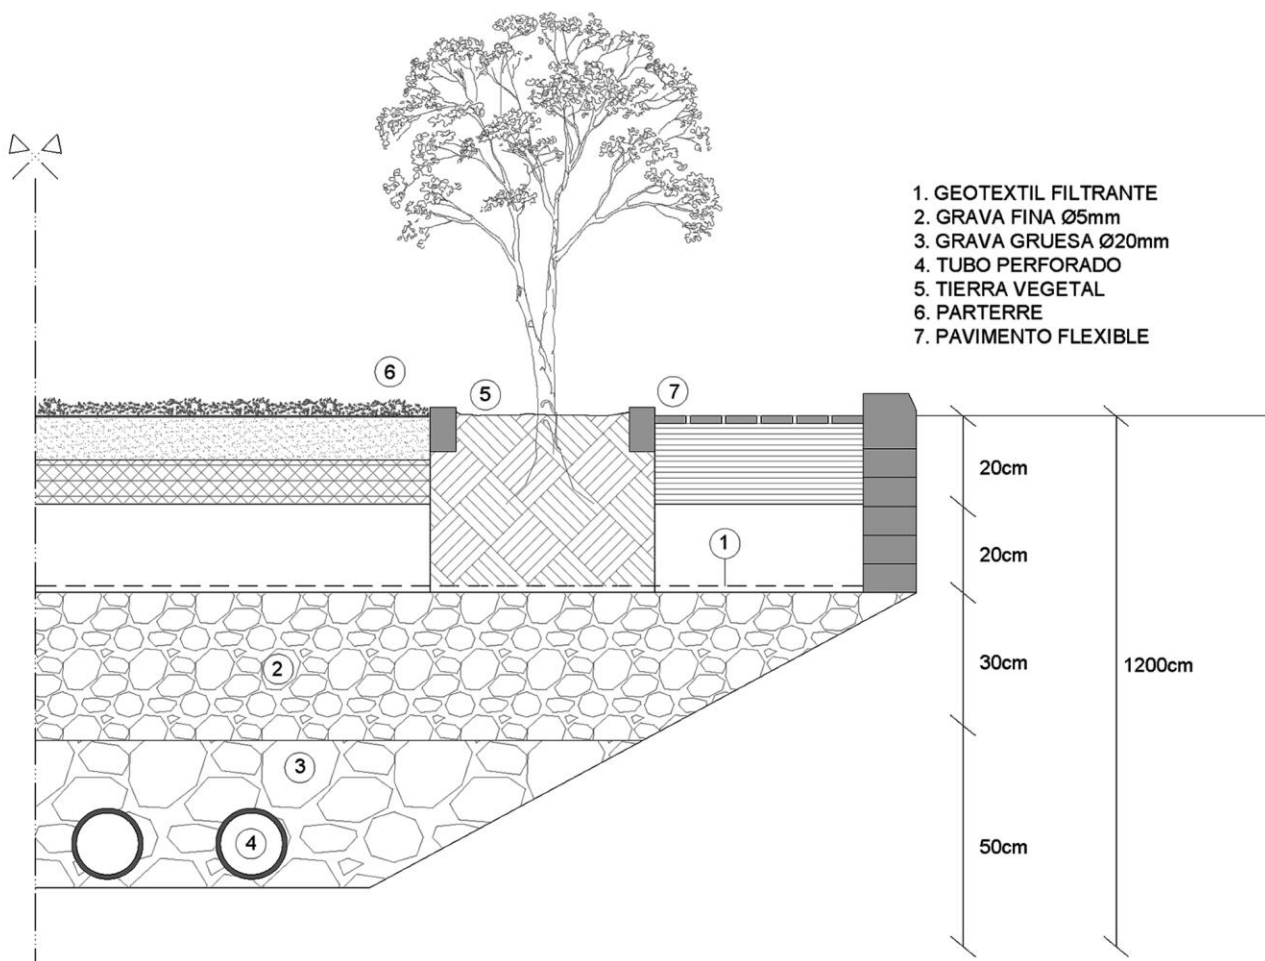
Pavimentos drenantes y de filtrado adecuados para paseos y bulevares.
